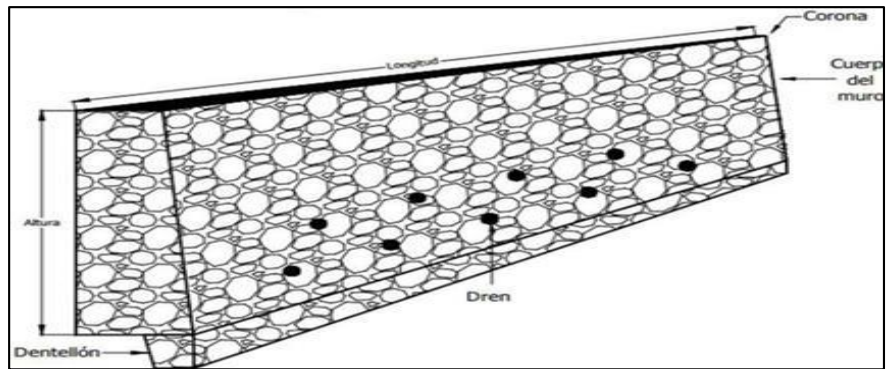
Muro de mampostería de piedra Braza y dentón, para riesgos de deslizamiento
